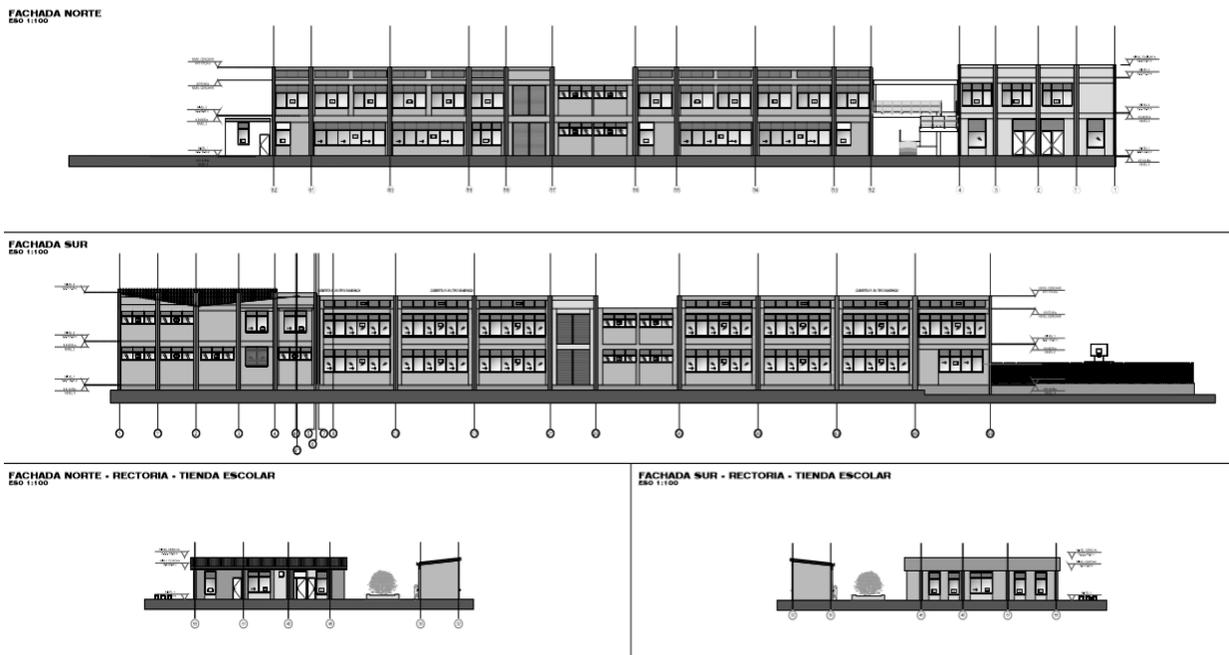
Planos Arquitectónicos, 2 planta de la Institución.
